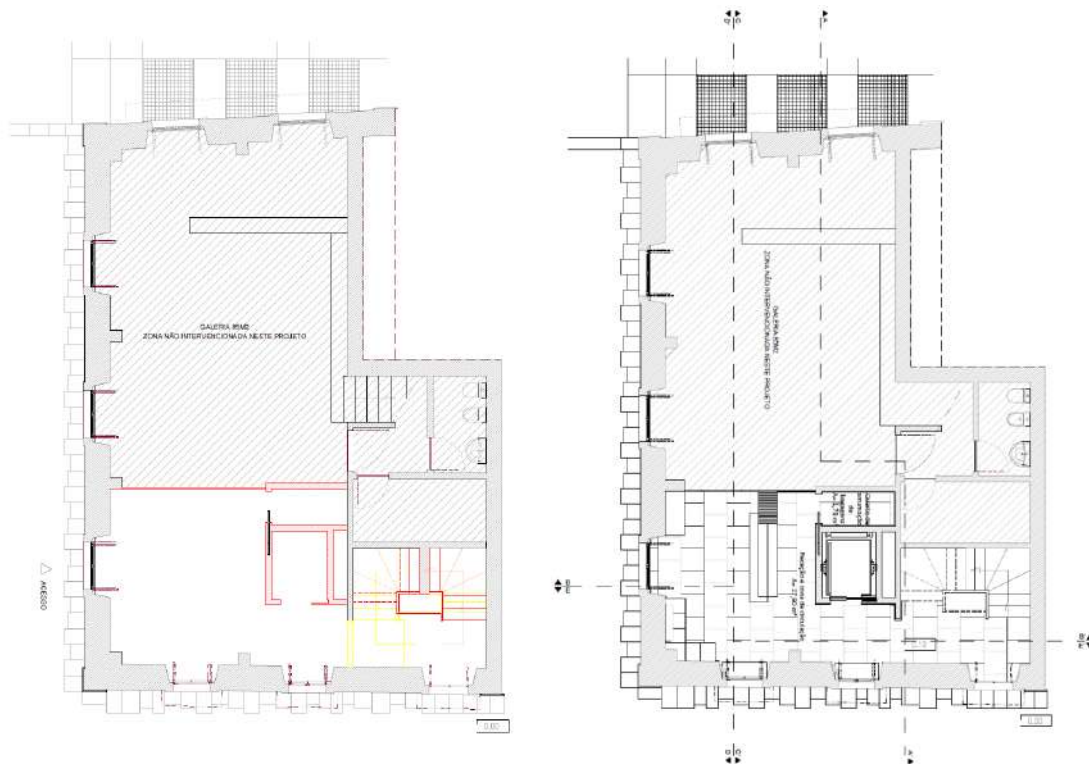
Planta de Alterações e Planta de Apresentação (Piso 0)
